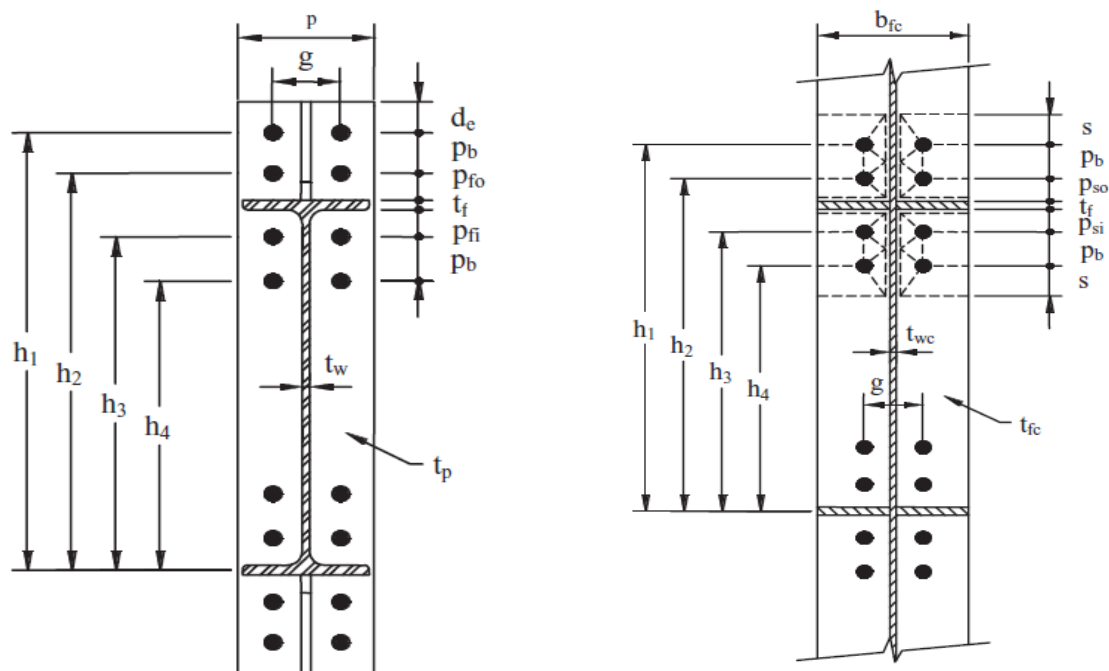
Geometría de la unión – Ocho pernos con rigidizador extendido
